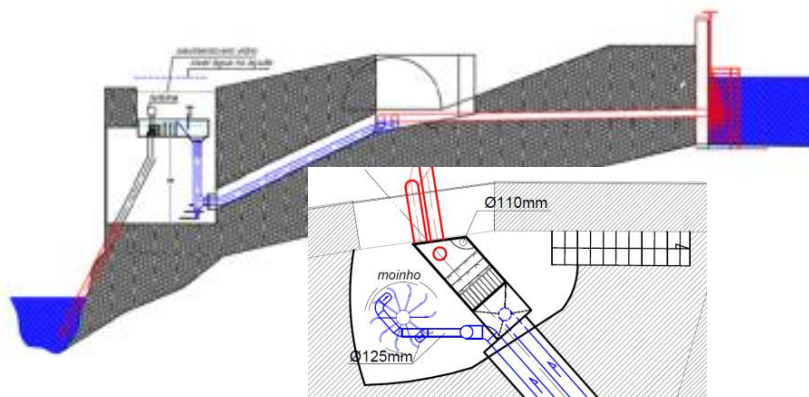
Corte transversal do terreno e detalhe da vista superior do dique, tubagem e galeria com a roda de água horizontal do moinho e turbina.
